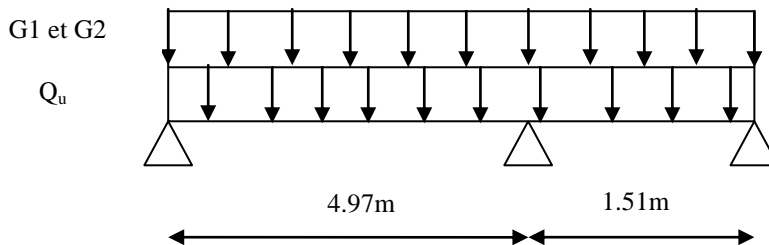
Schéma statique de la poutre brisée (escalier type 1)
